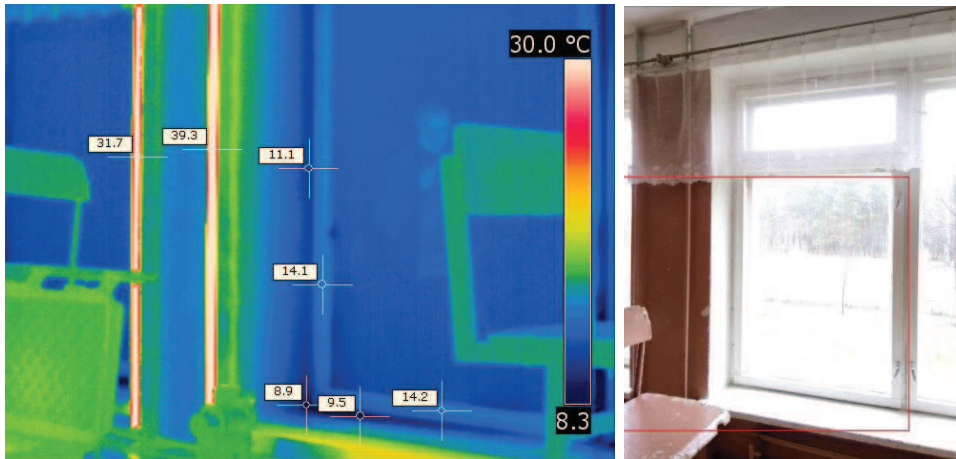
Стена помещения №114 (мастерская по металлу), северный фасад
